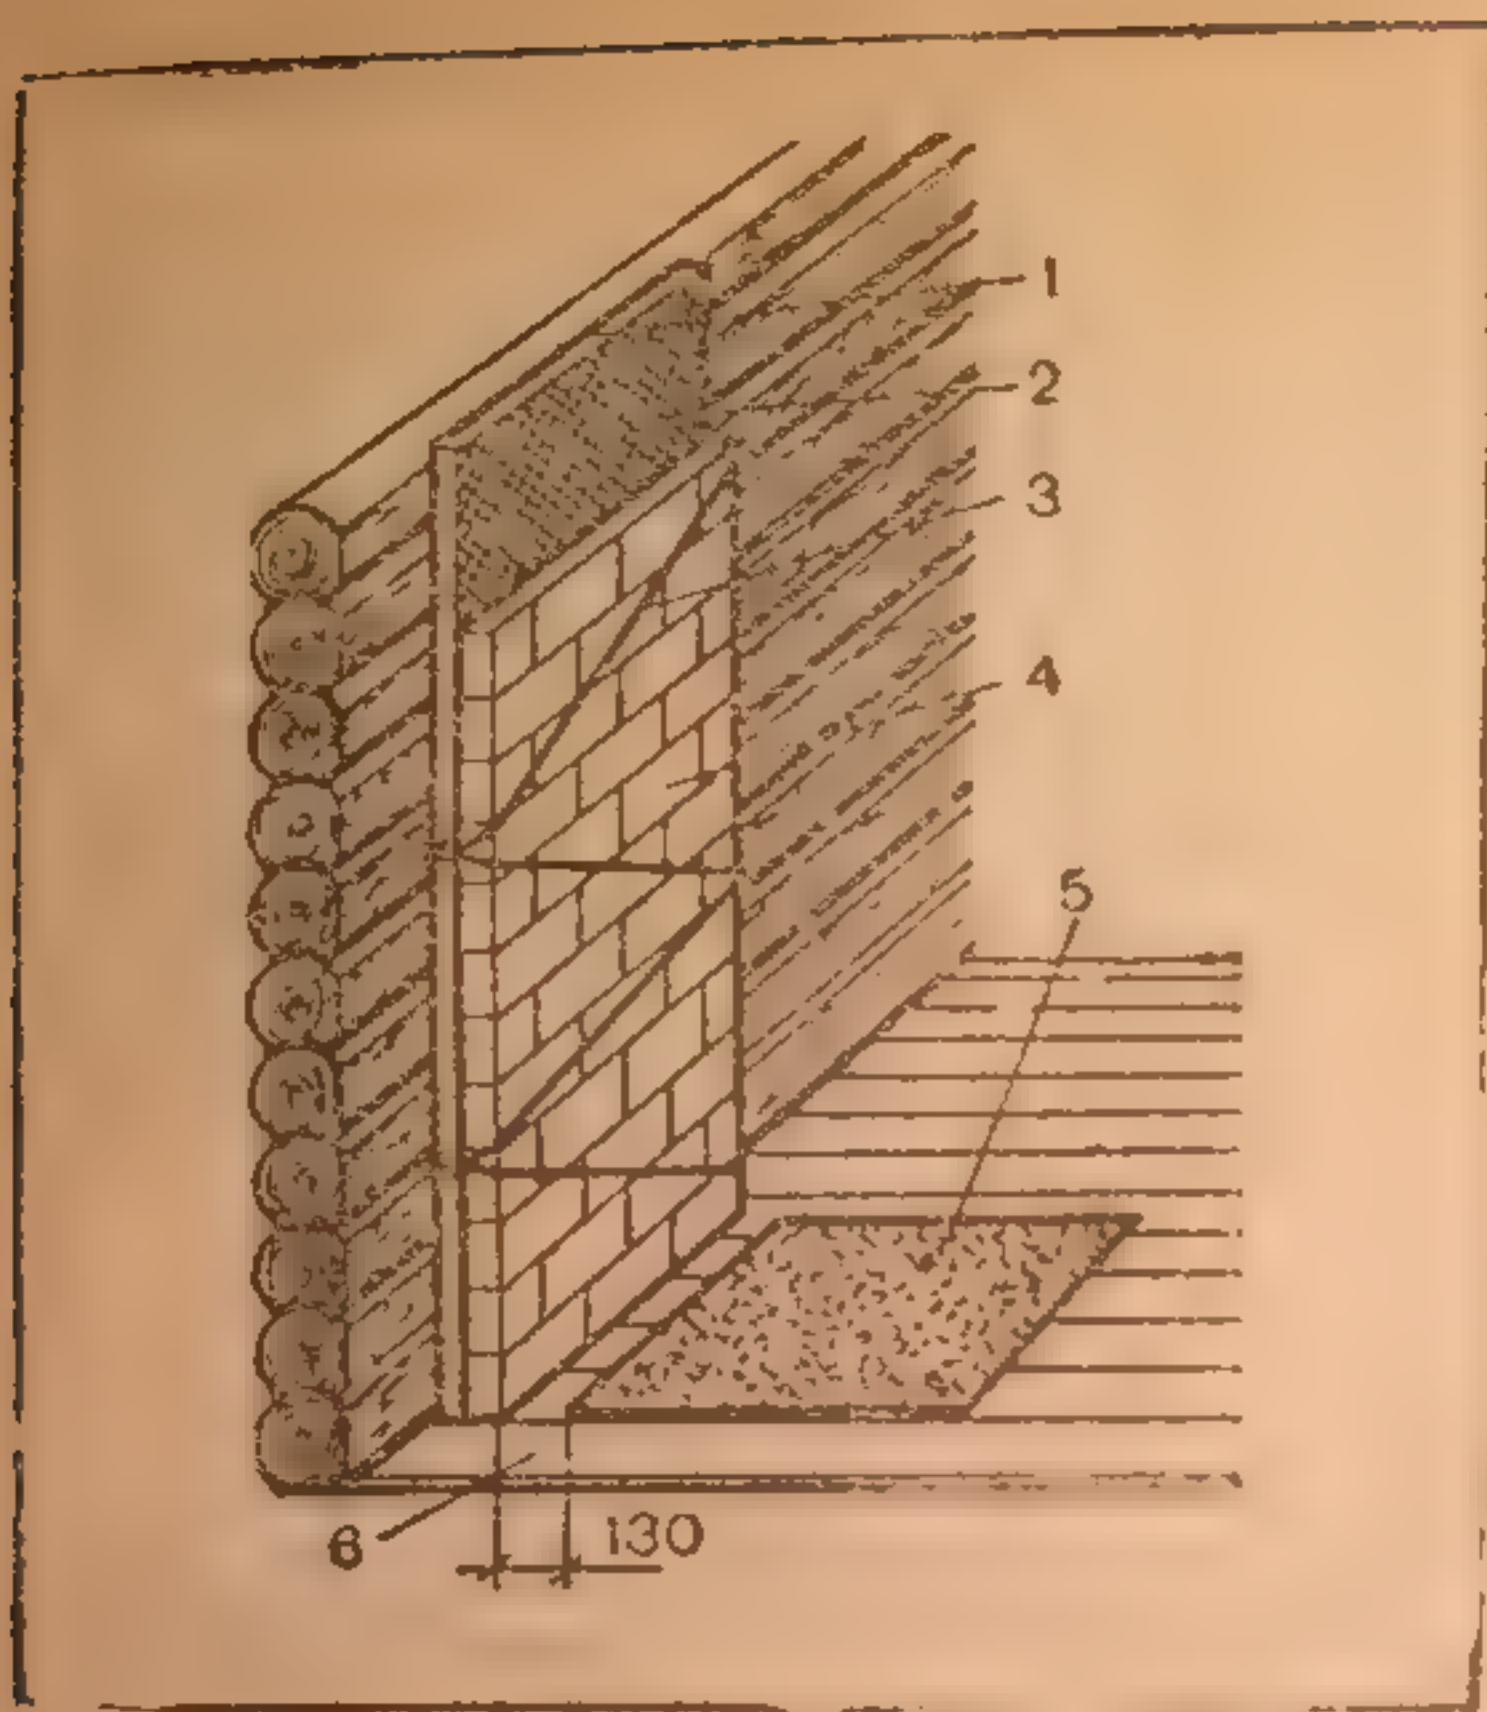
Изоляция деревянной сгораемой стенки кирпичом:
